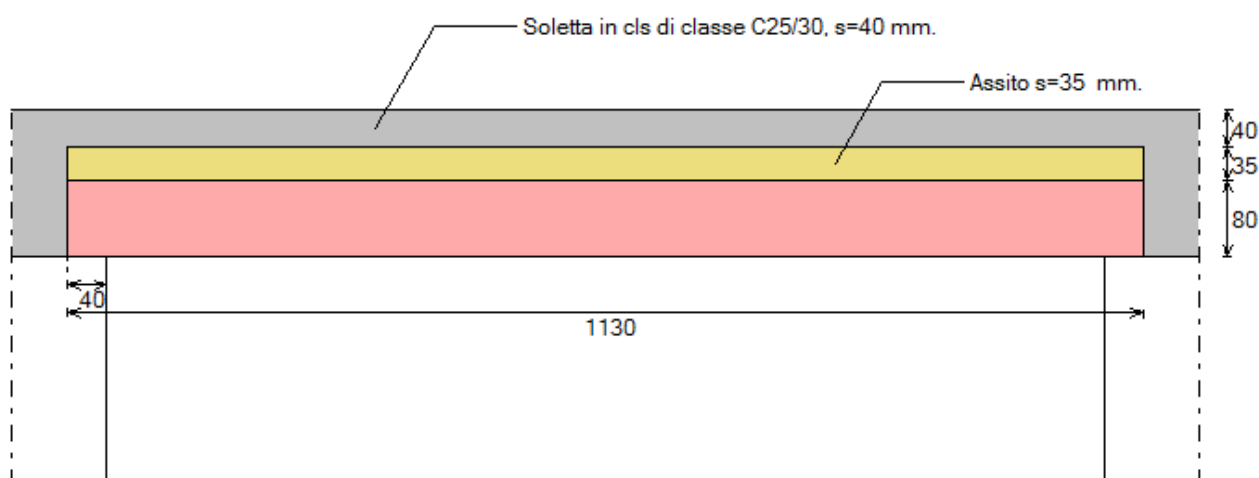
Grafica: Sezione D-D: Prospetto Travetto
